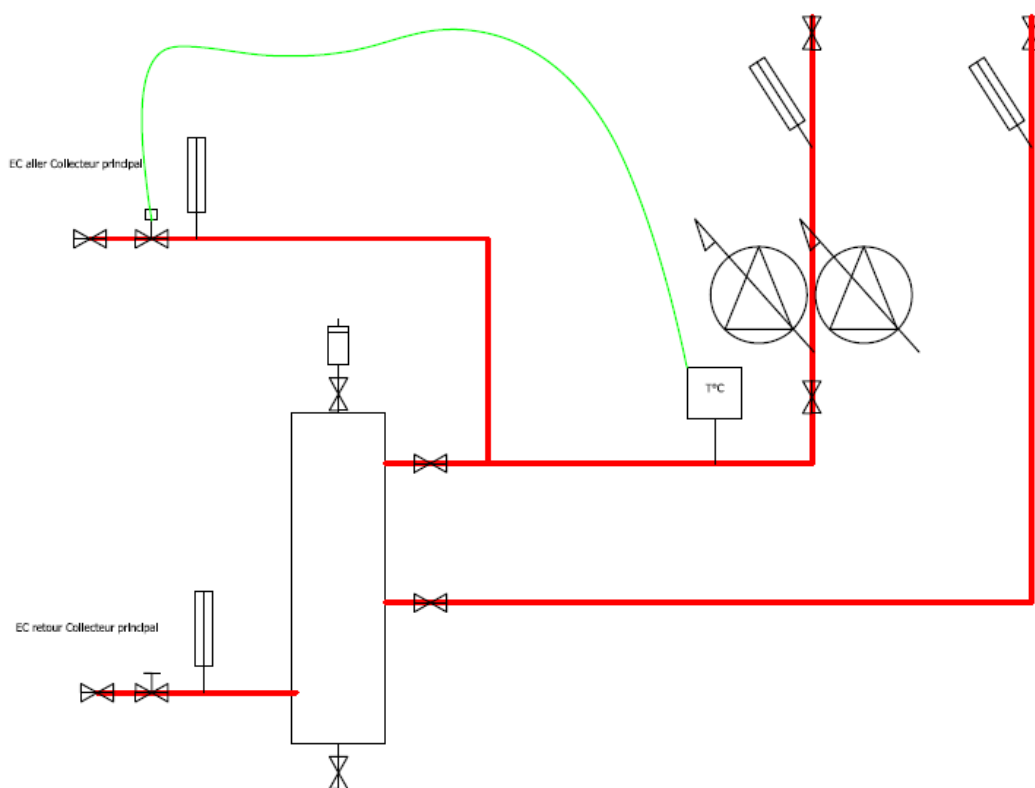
Schéma de principe Chauffage - Local Technique Sous sol
